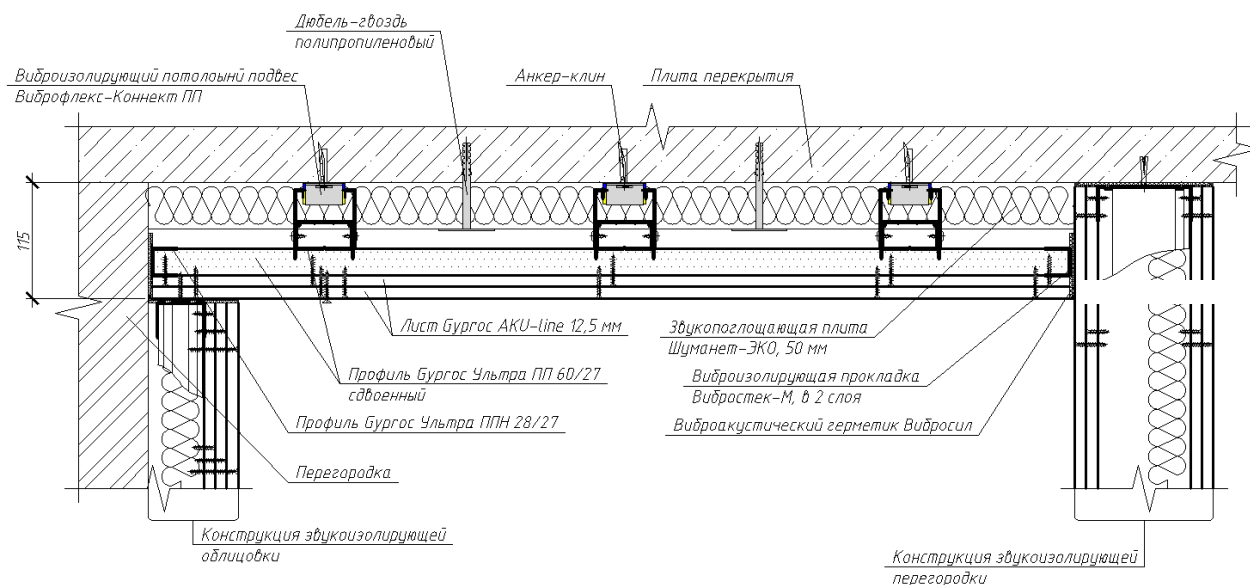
Схема-разрез подвесного ЗВИ потолка
